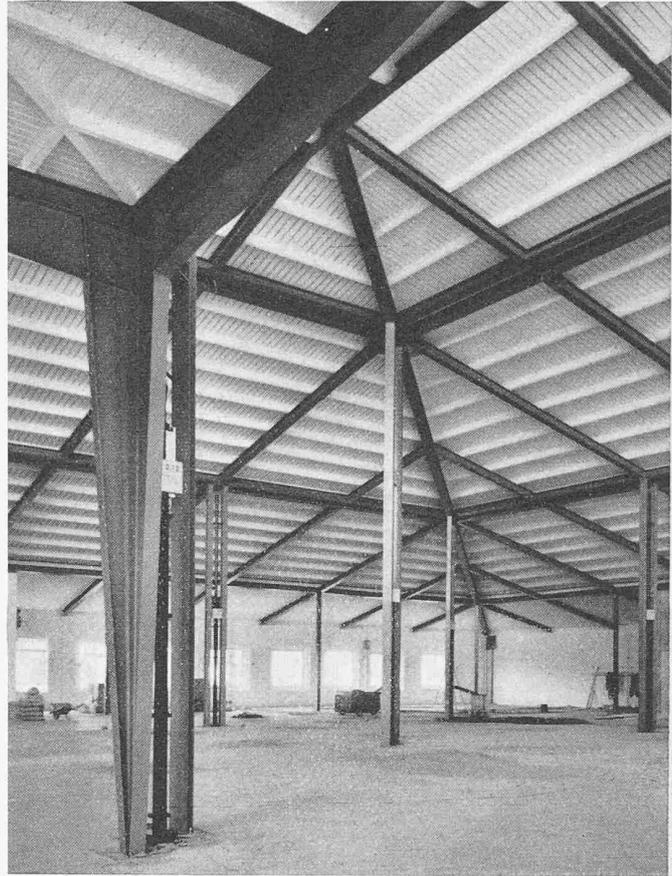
Eckkonstruktion im zweiten Stock. Vorn räumliche Rahmenkonstruktion zur Fixierung der vordern Windrahmenreihen. Dahinter Gratausbildung mit Anschluss an Fassadenmauern, Eisenbetondachdecke als Gebäudeaussteifung
